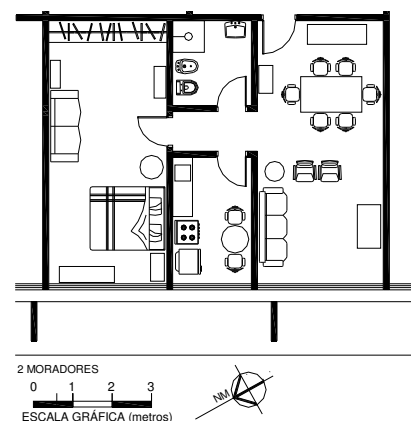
Layout de apto. de 1 dorm. do bloco F.
